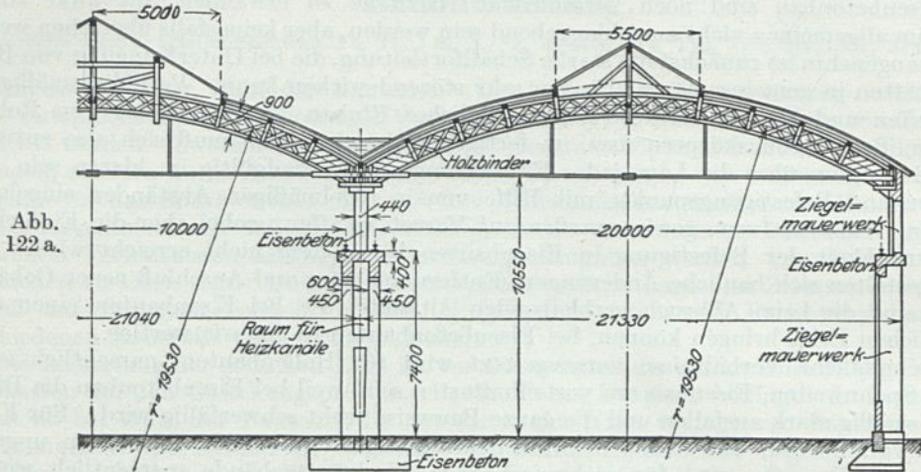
c. Dreischiffige Walzwerkhalle mit Eisenbetonstützen und Holzbindern. M. 1 : 300.
